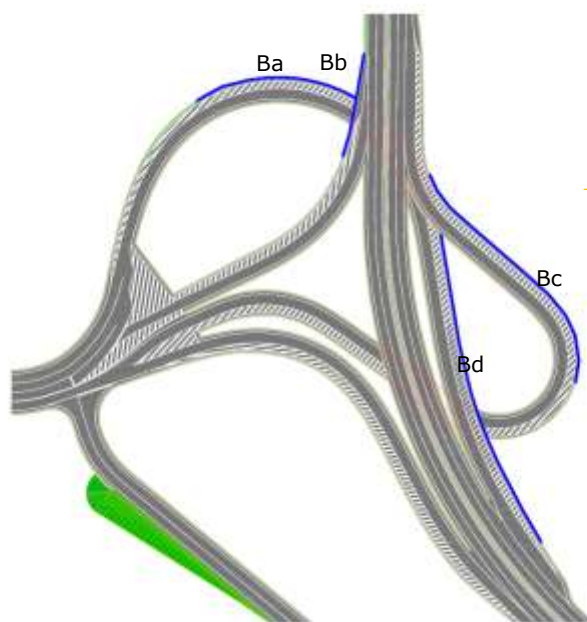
Barriere antirumore previste lungo le rampe di collegamento con la GVT
